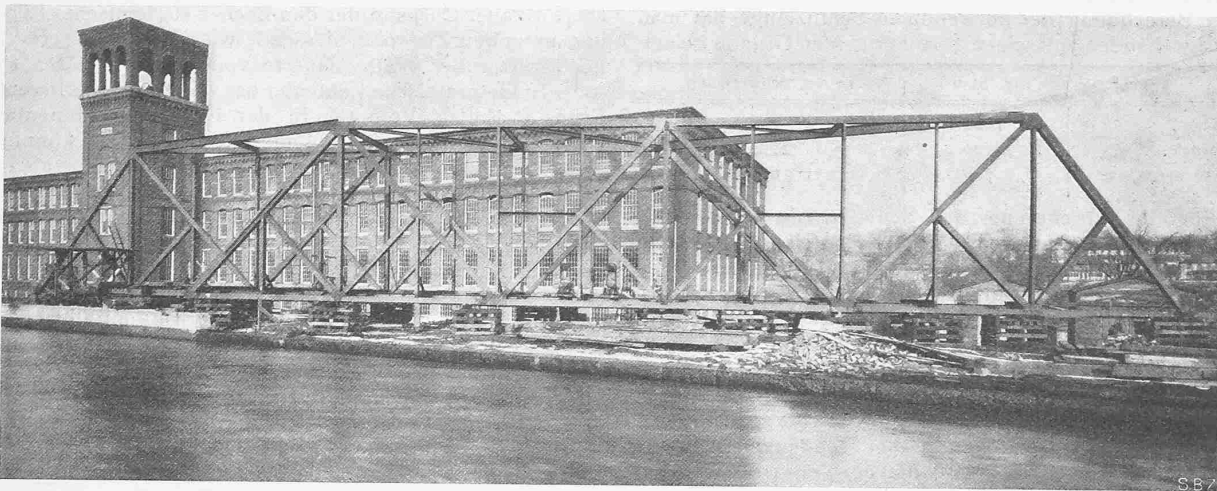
Geschweisste Fachwerkbrücke von 53 m Länge, auf dem Montageplatz. [Der Fabrikbau im Hintergrund stammt aus dem Jahre 1874. Red.]
